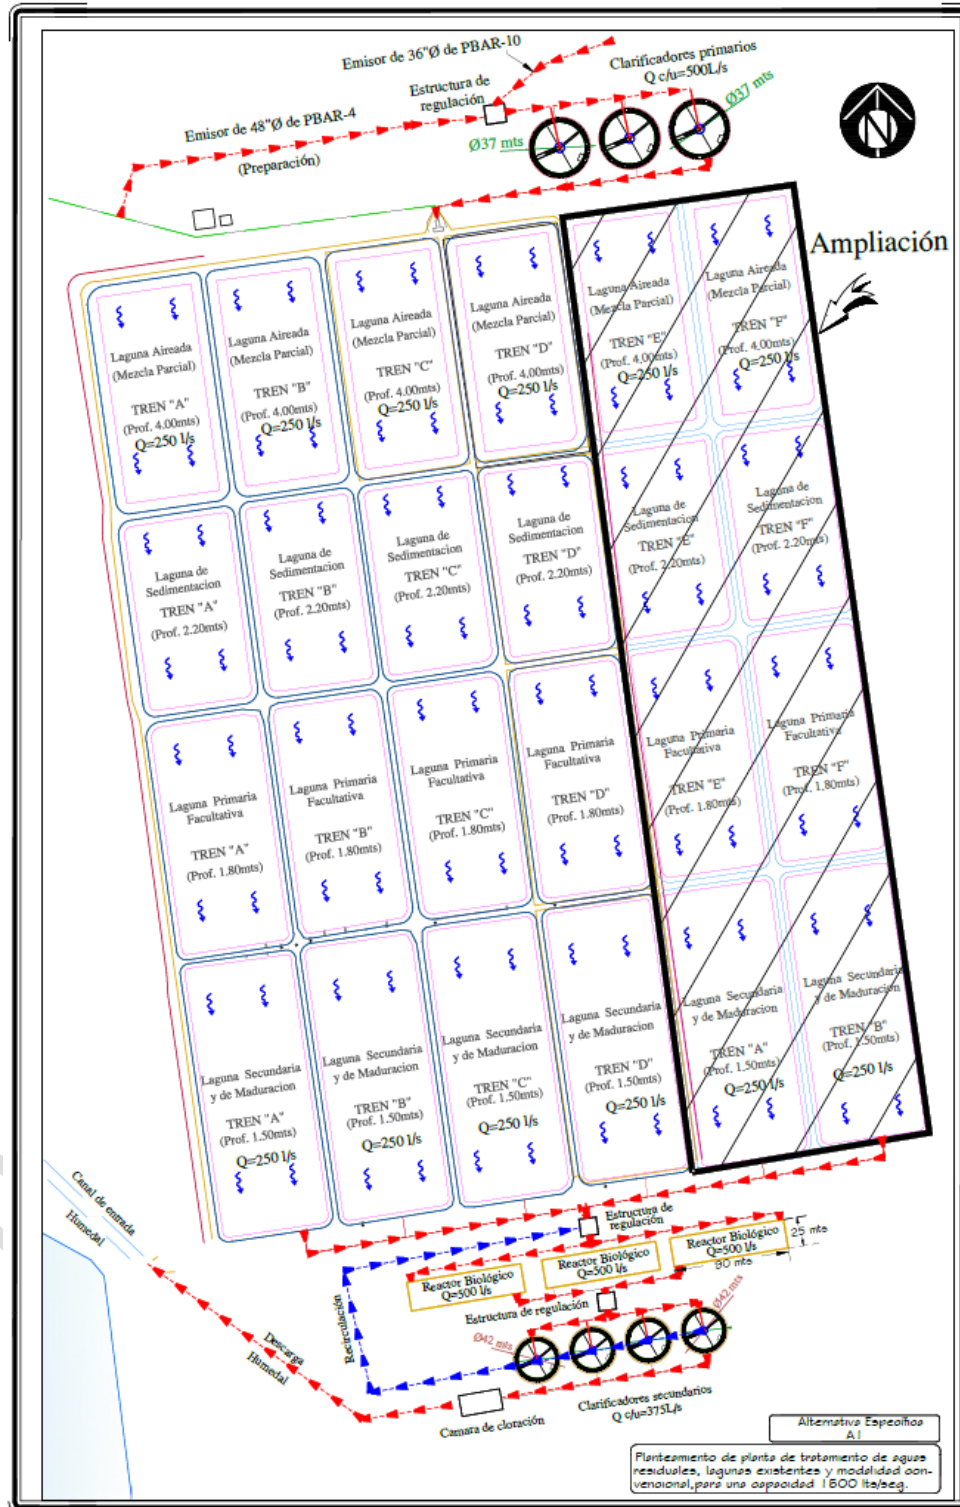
Alternativa A1. Reingeniería de la planta actual y ampliación de la capacidad de tratamiento hasta 1,500 L/s mediante una planta de lodos activados convencional.
